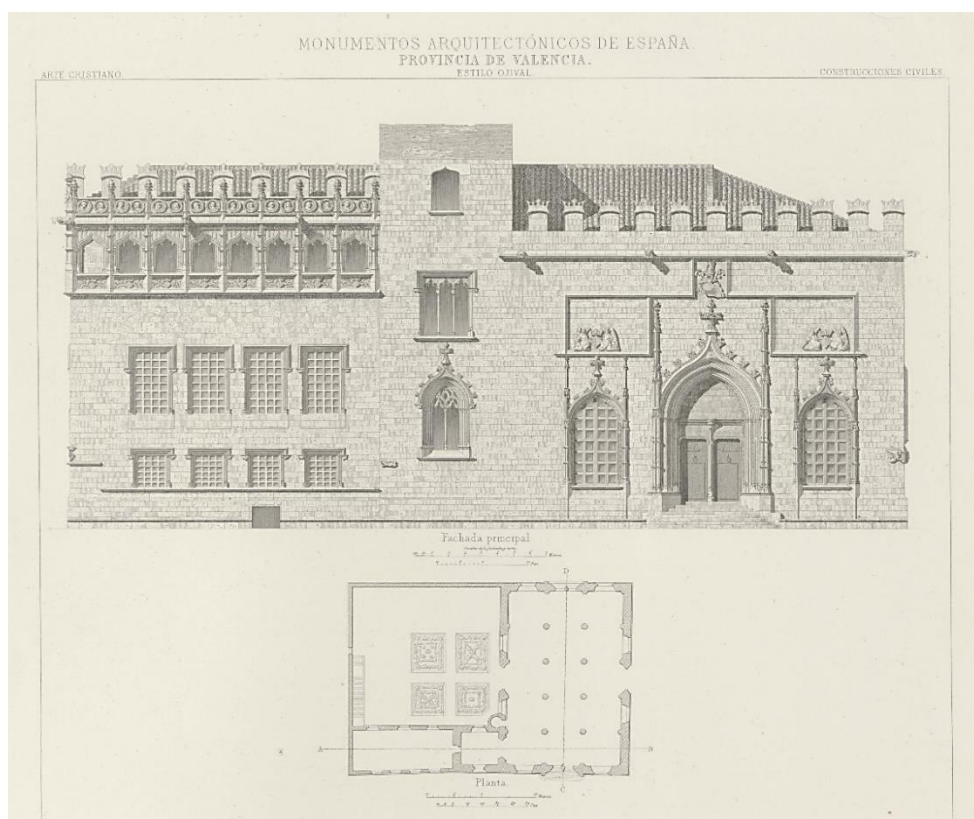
Planta y alzado del conjunto de la Lonja.
